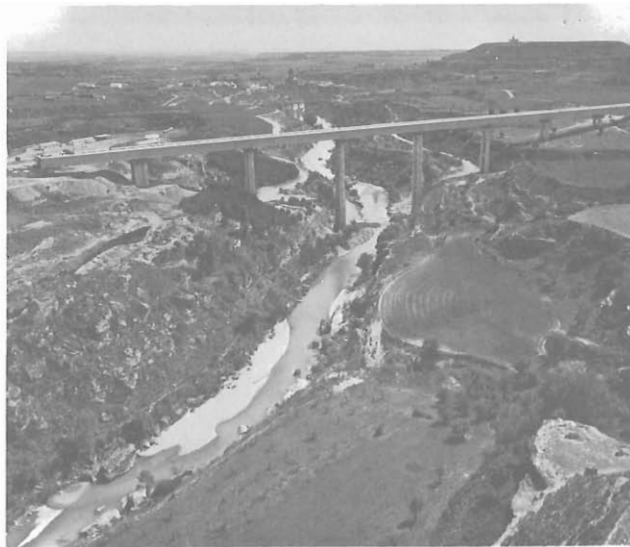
Puente de Alcanadre. Vista general del puente.
